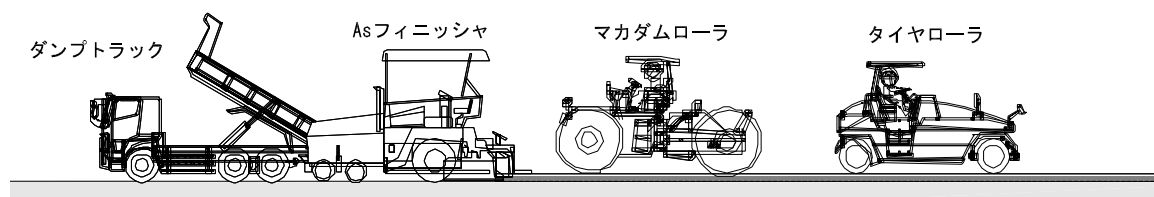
アスファルト舗装工（基層）の施工状況
